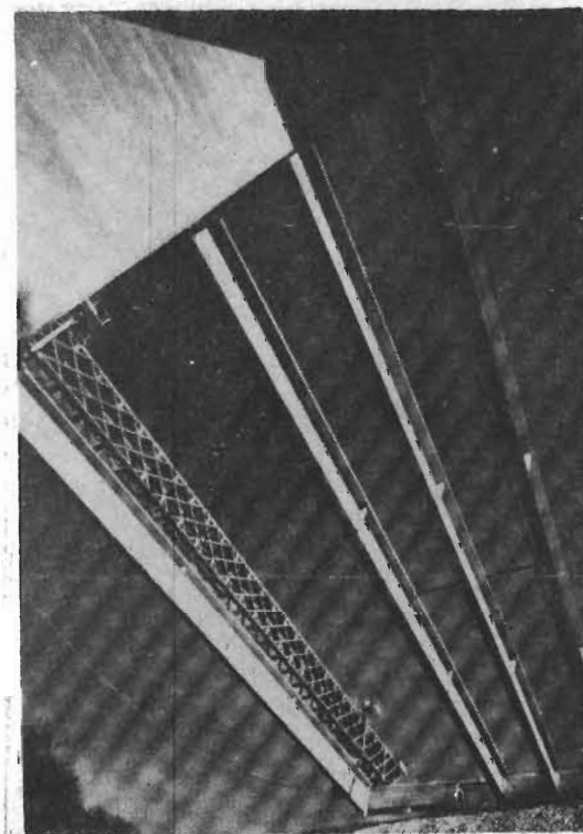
Puente Pfädschensgraben; la viga prefabricada avanza mediante el equipo de montaje.
